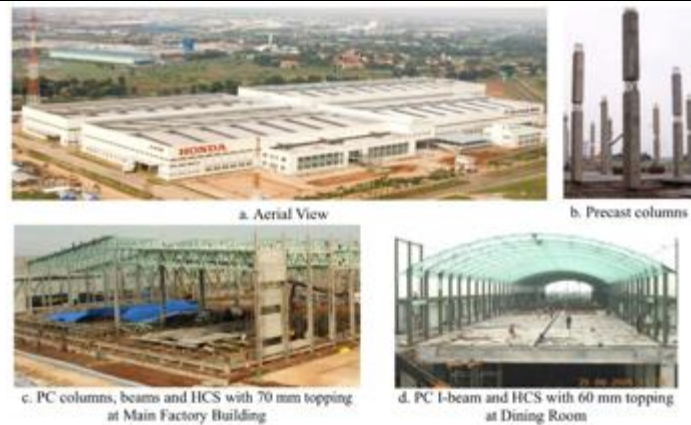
Planta de Astra-Honda en Indonesia (Wijanto & Andriono, 2008).
